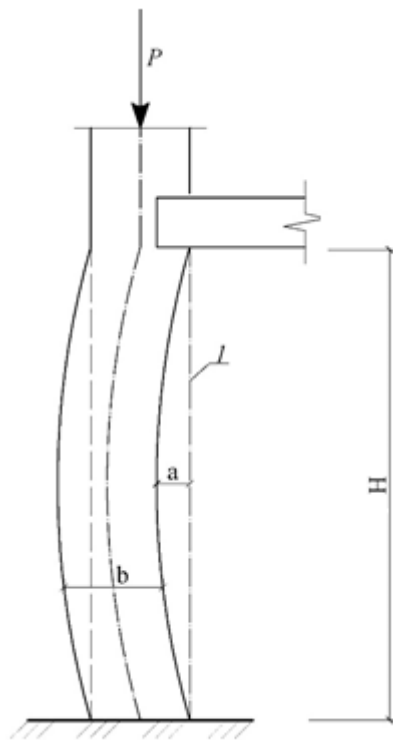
Схема определения выгиба колонны: 1 – линия отвеса; a – расстояние от отвеса до колонны; b – толщина сечения колонны (измеряют для колонн из древесины); H – высота колонны.
